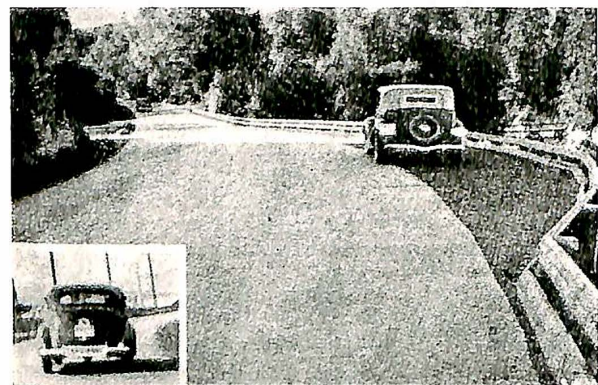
Betongvei utenfor Oslo med bitumenstripe på utsiden. Nede til venstre: Skilt for lærekjøring.
